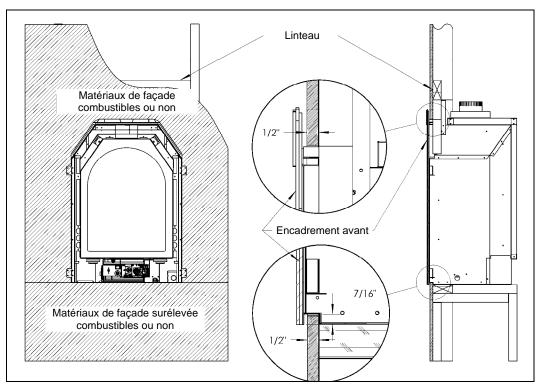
Installation des matériaux de façade de 1/2" d'épaisseur.
